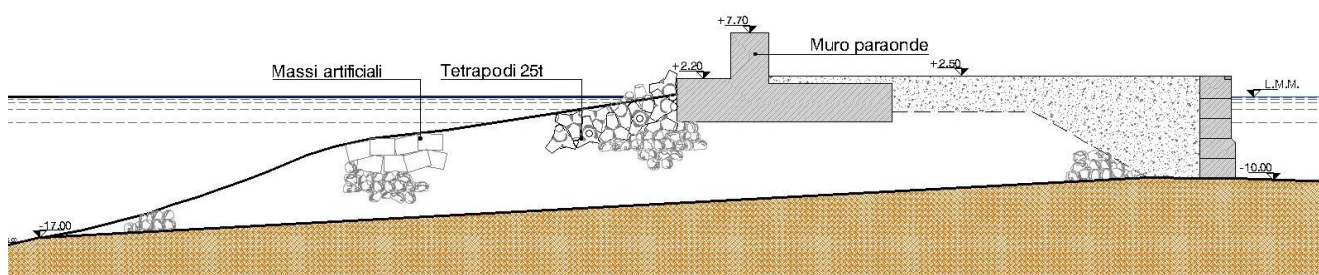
Sezione tipo dell'antemurale Traiano in corrispondenza della banchina traiana
